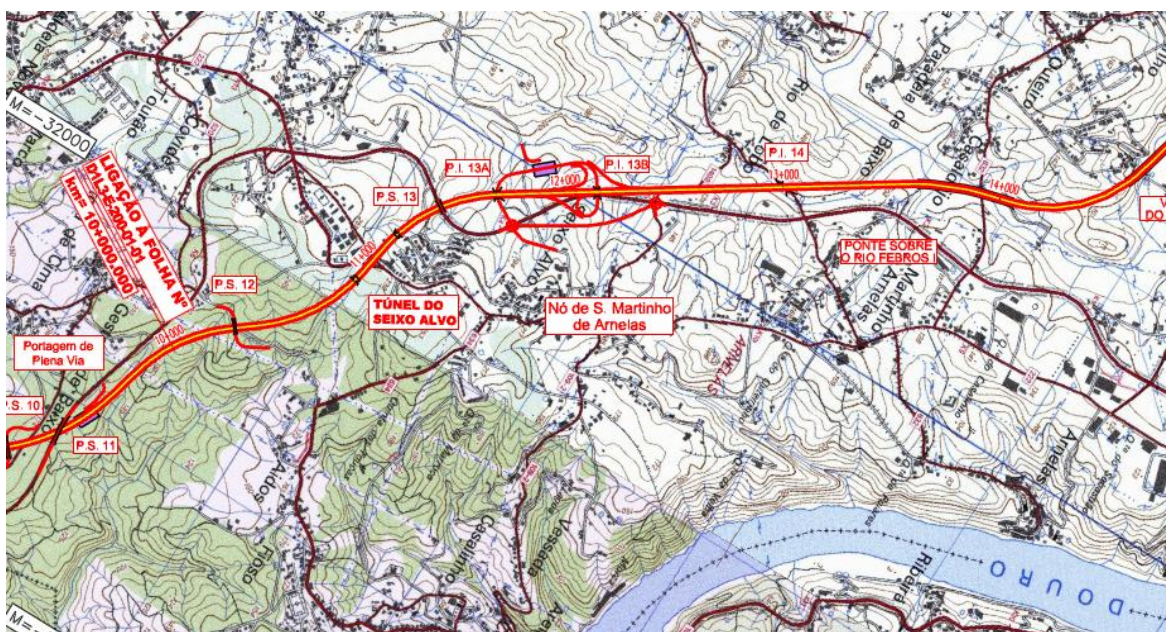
Planta de localização (adaptado de Coba, 2009)
